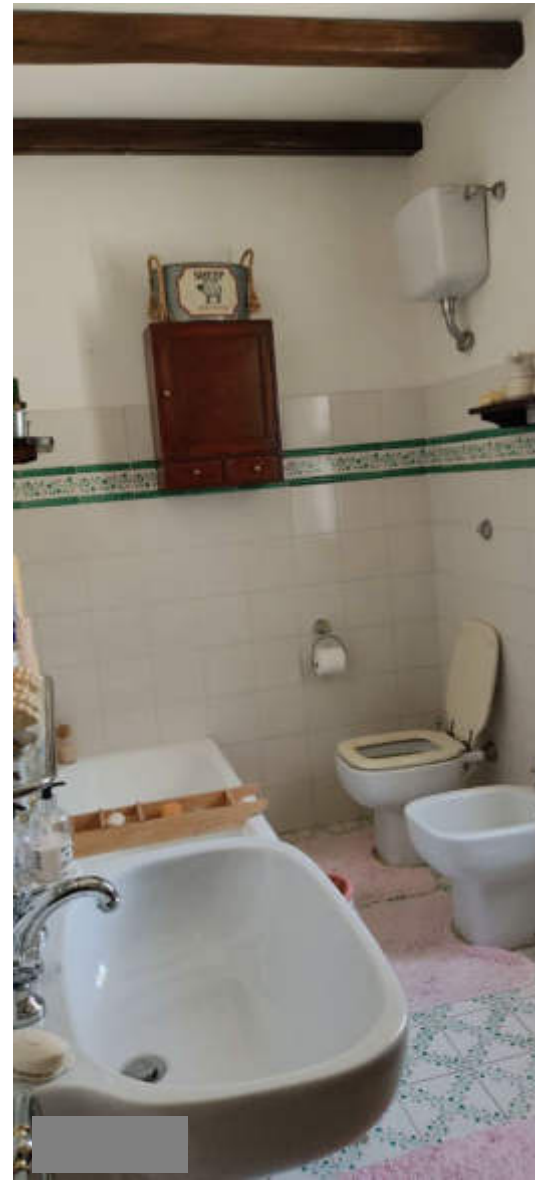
, 29 e 30 – Vista interna piano terra, scala di collegamento e piano primo
